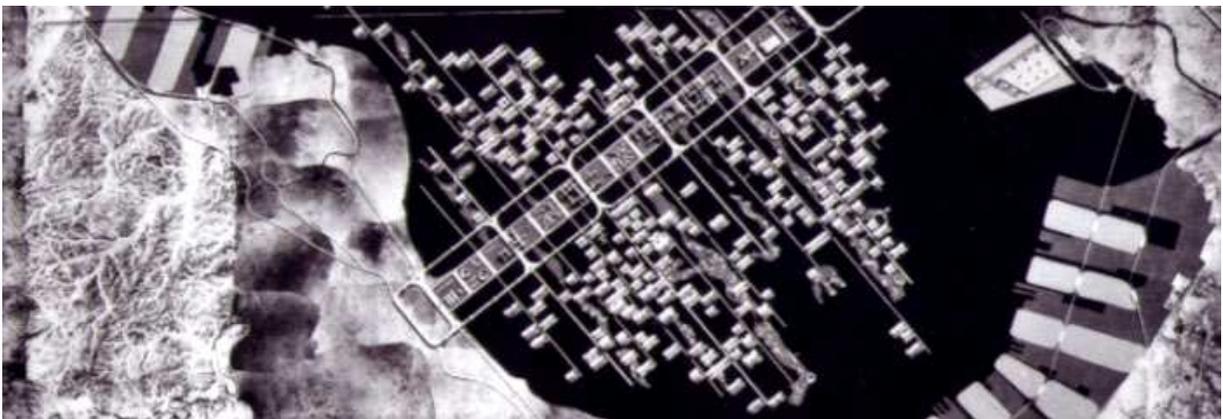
Plano para baía de Tóquio, 1960 de Kenzo Tange.
